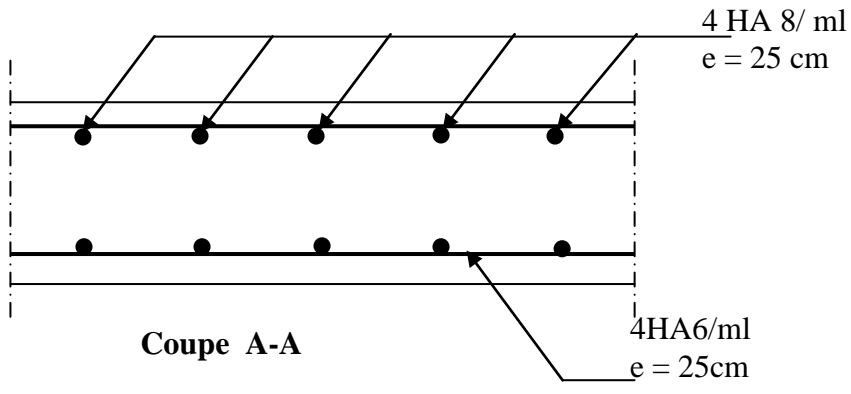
Schéma de ferrailage de l'acrotère
